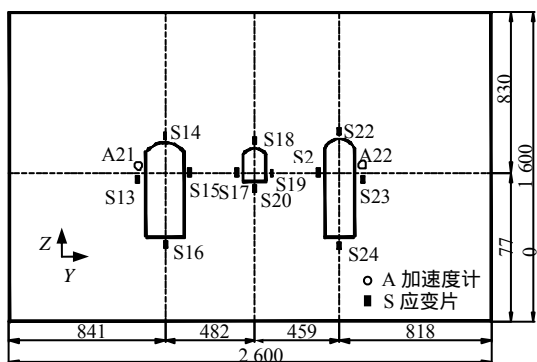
辅助测试断面 1 传感器的布置图 (单位: mm)
